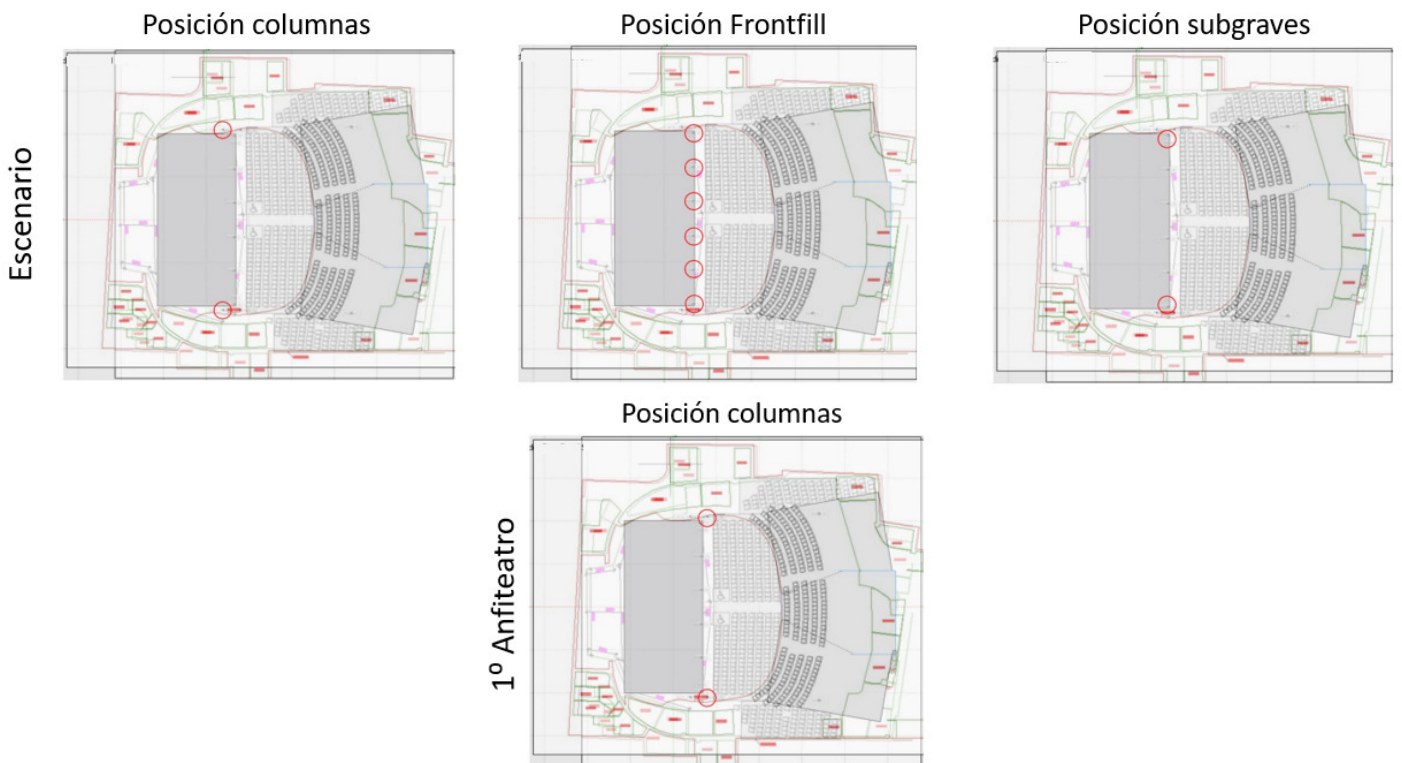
Plano planta de posición aproximada de los conjuntos de altavoces.
